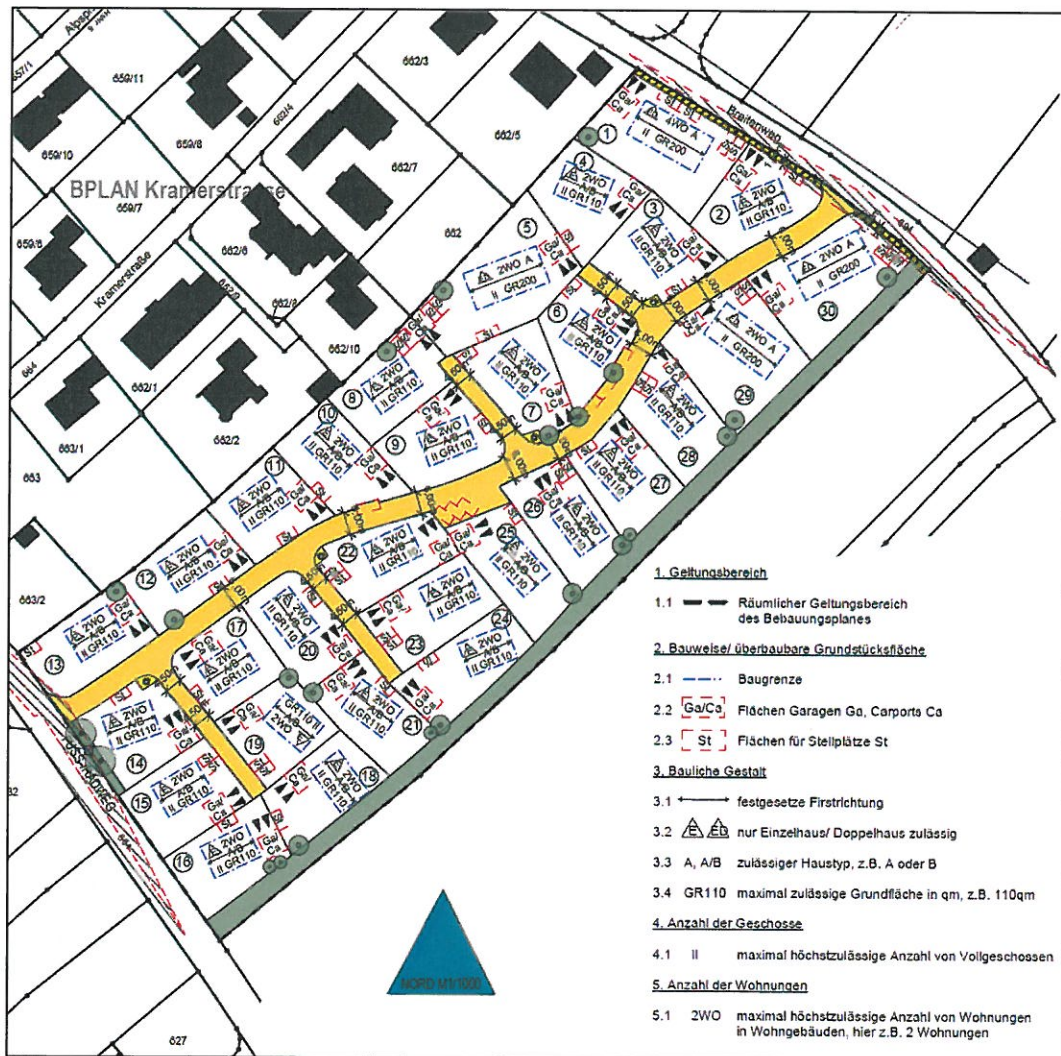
Ausschnitt aus dem Bebauungsplan (Planentwurf vom 29.02.2016)
